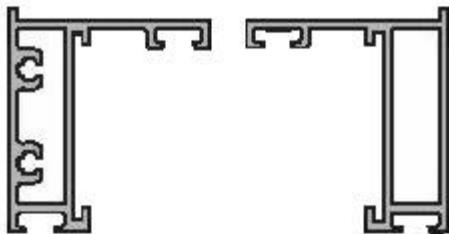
Perfil Combinado para Hoja de Piel de Vidrio (Muro Cortina)
